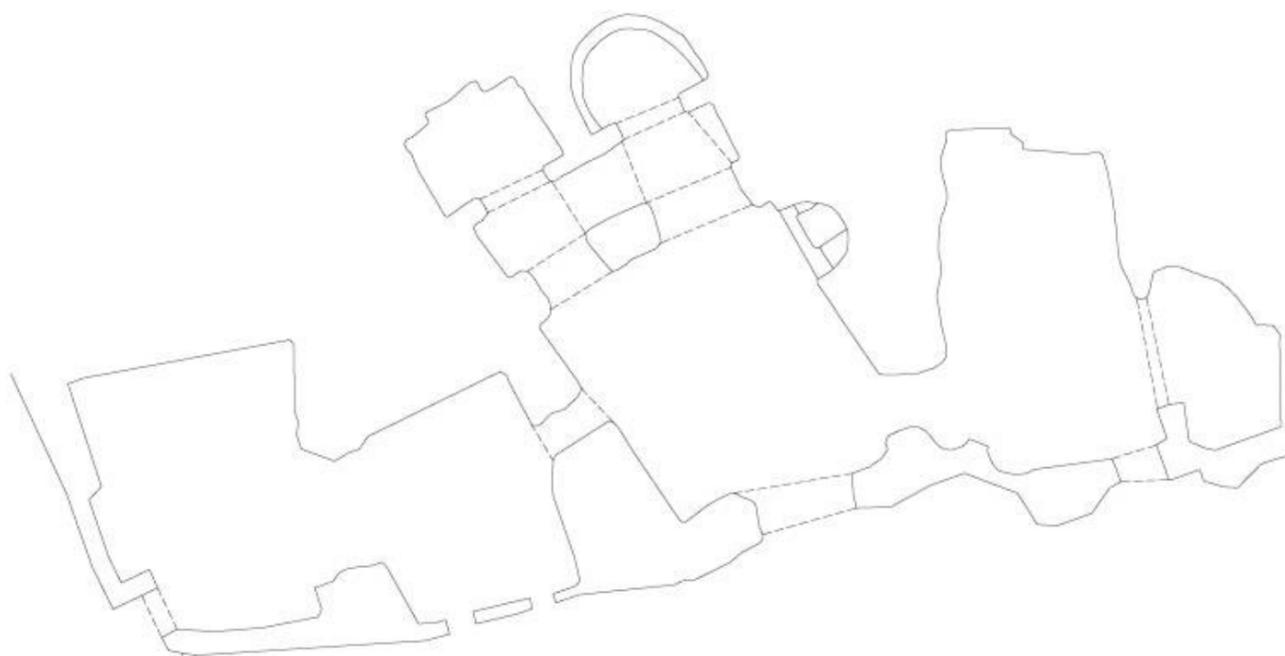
Matera, chiesa rupestre di san Falcione, pianta (Rilievo da progetto del Parco)
